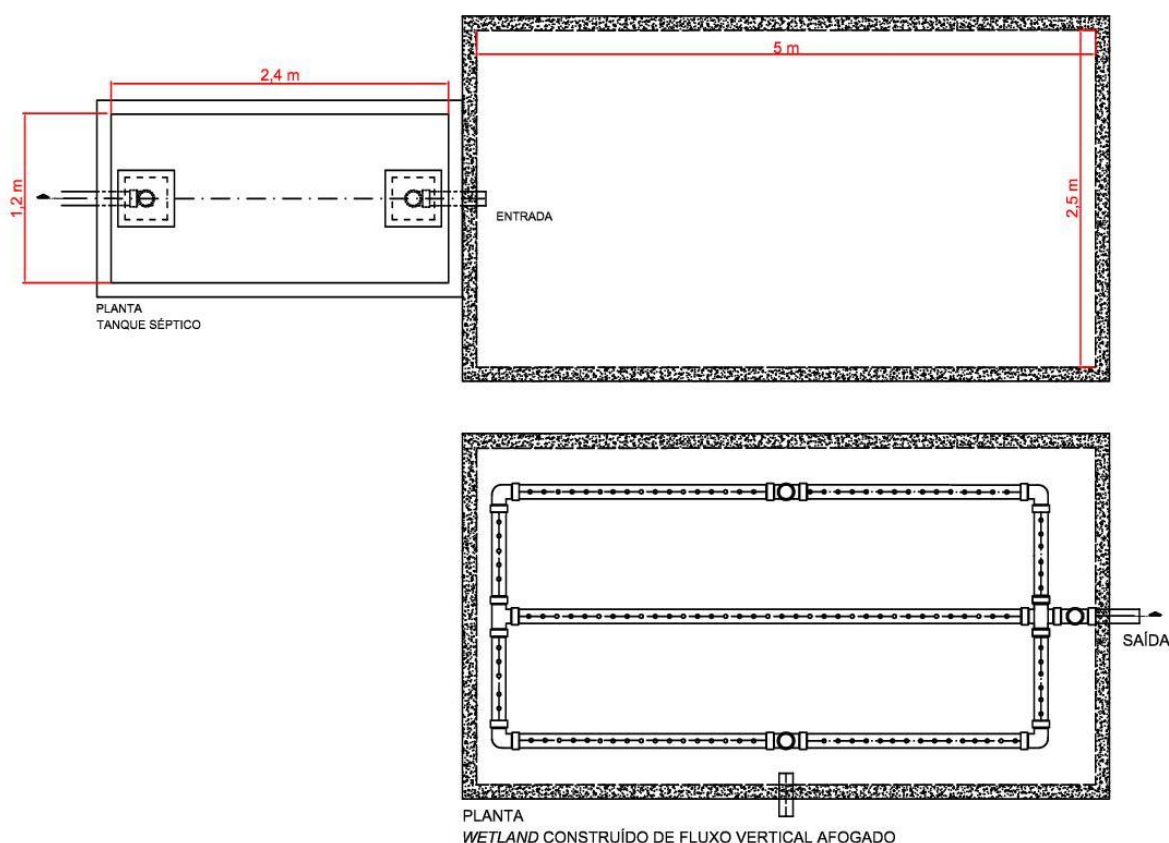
Croqui do sistema de tratamento de esgoto proposto (Planta Baixa)
